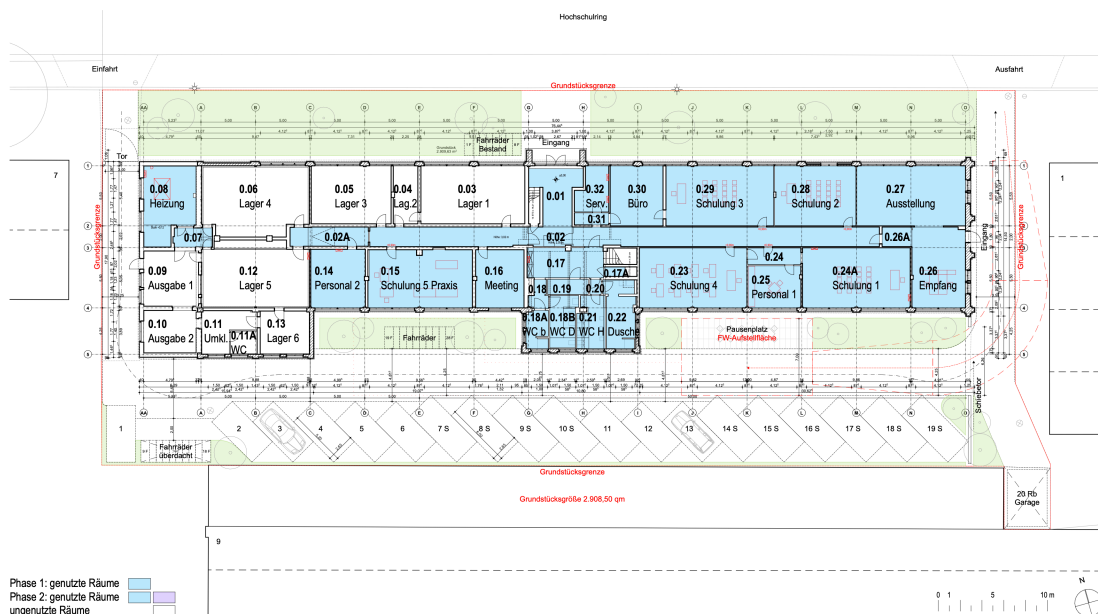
Phase I - Fortführung der Nutzung - Grundriss EG
